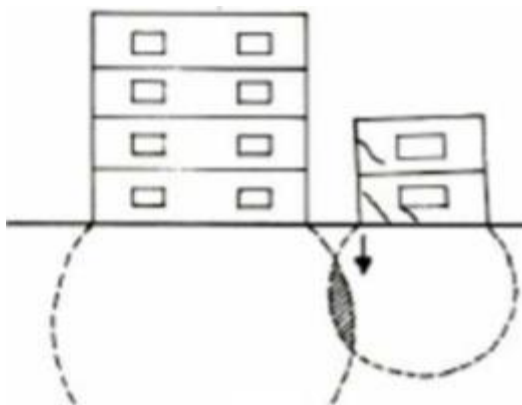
Encontro de bulbo de tensões gerado por fundações próximas.
